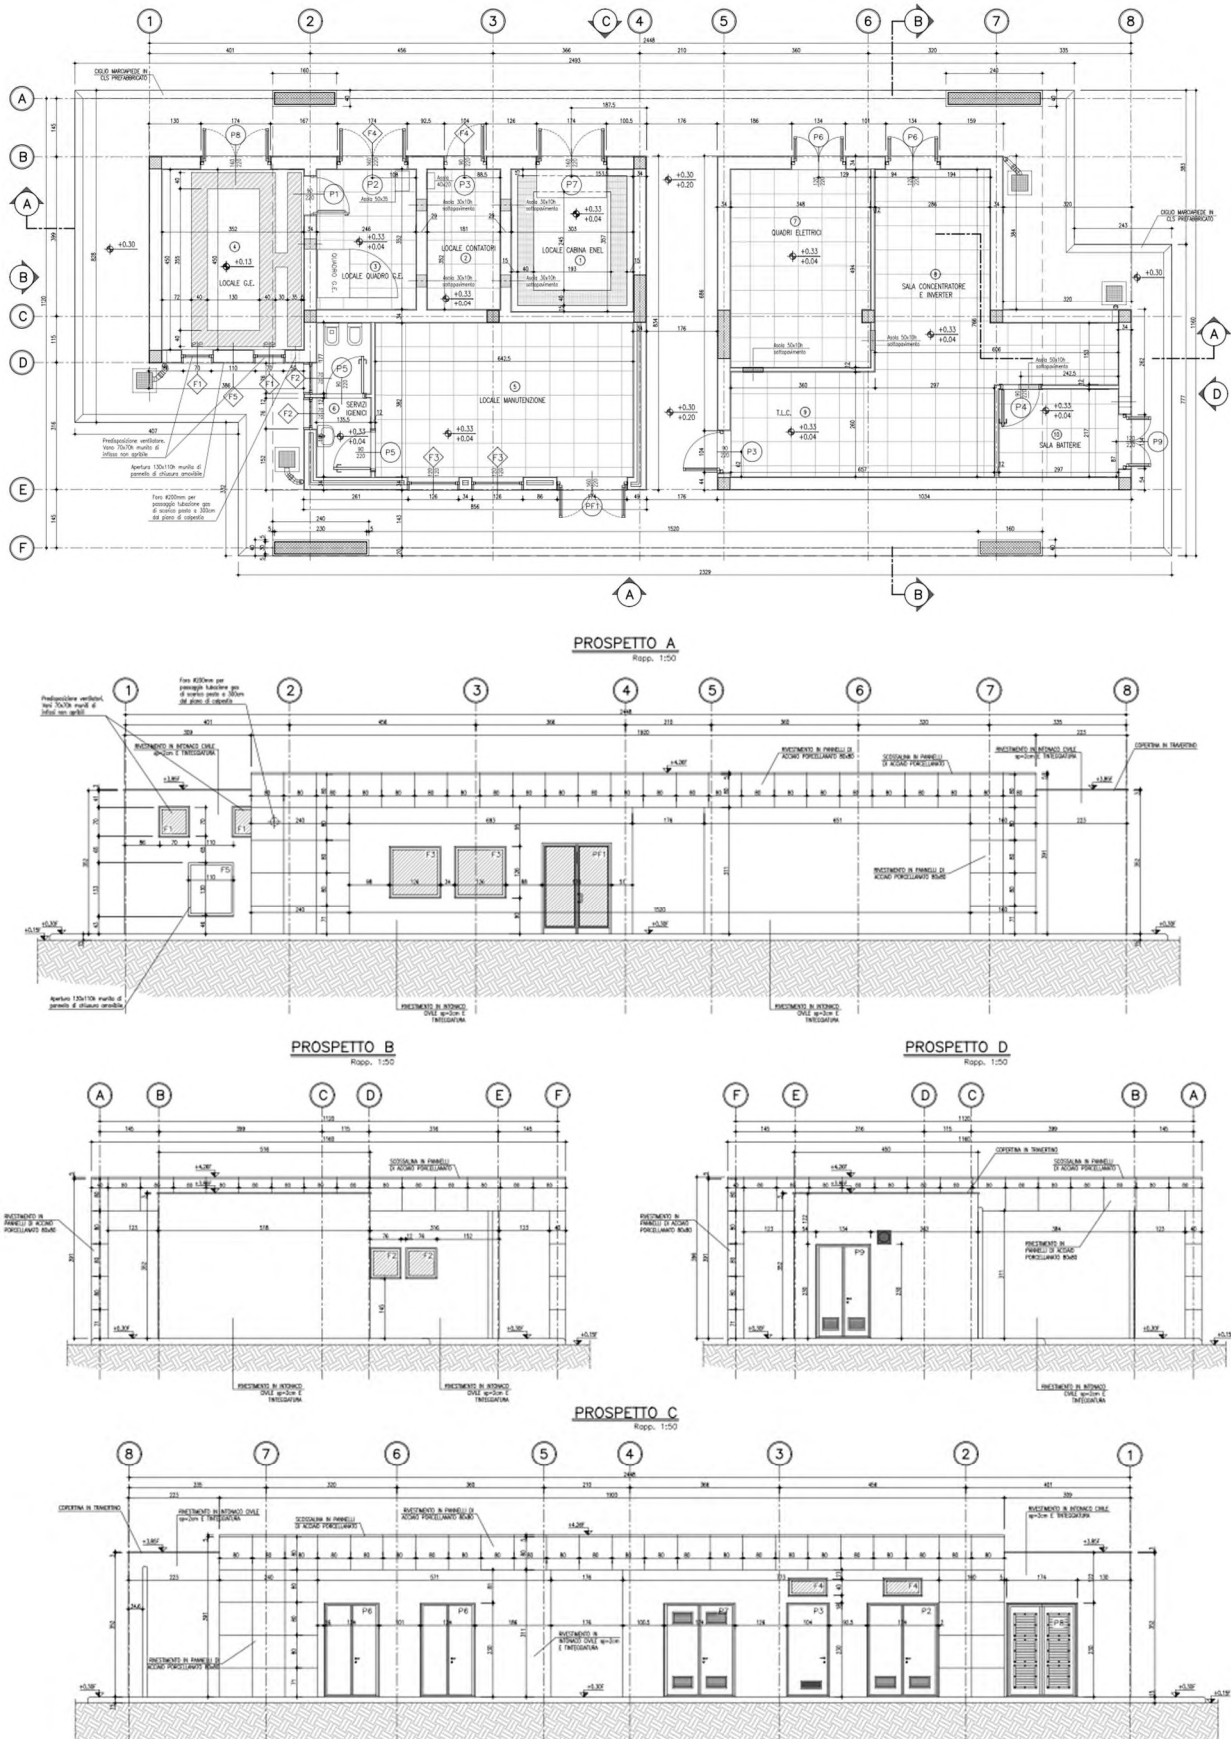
Fabbricato di stazione ed impianti - Pianta e Prospetti
